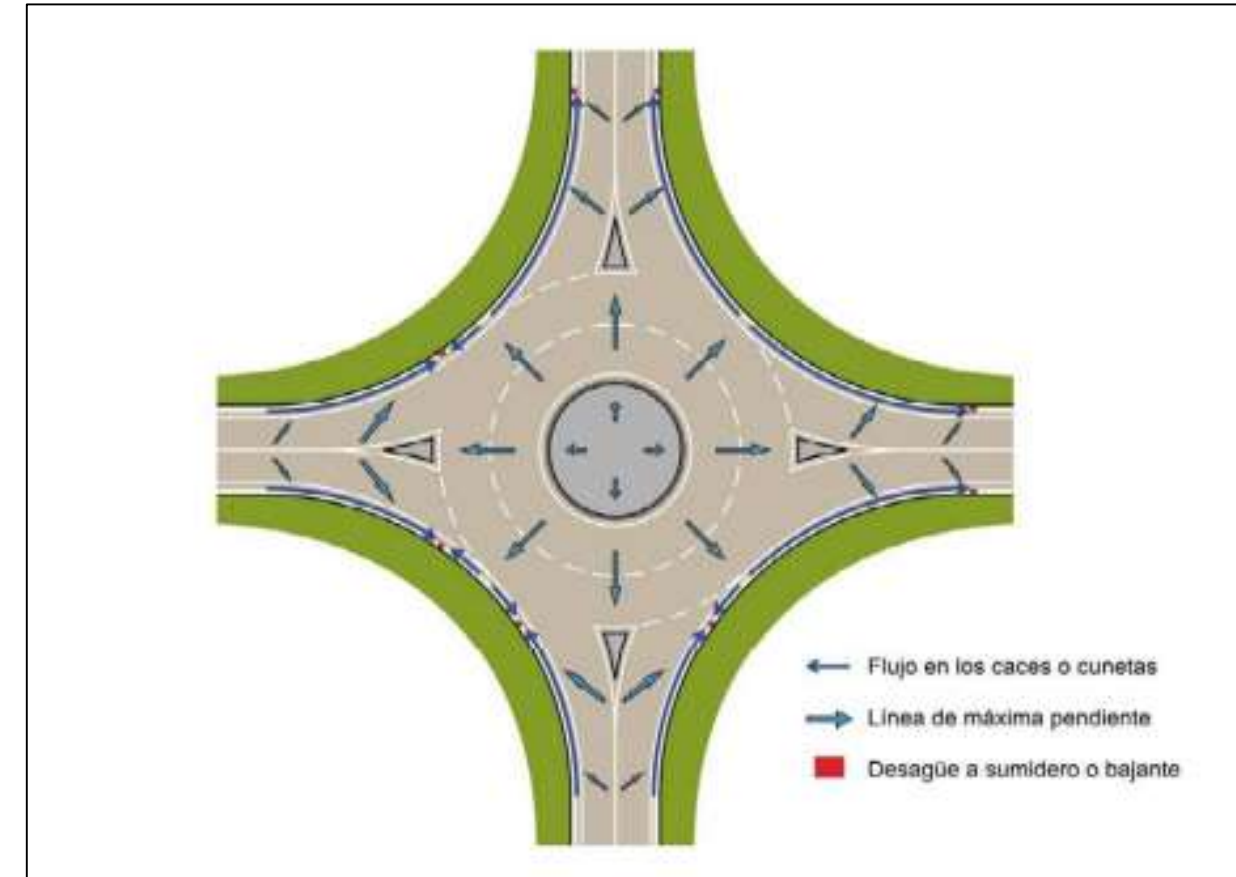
Pendientes de la glorieta y elementos de drenaje (norma 5.2-IC Drenaje Superficial)
